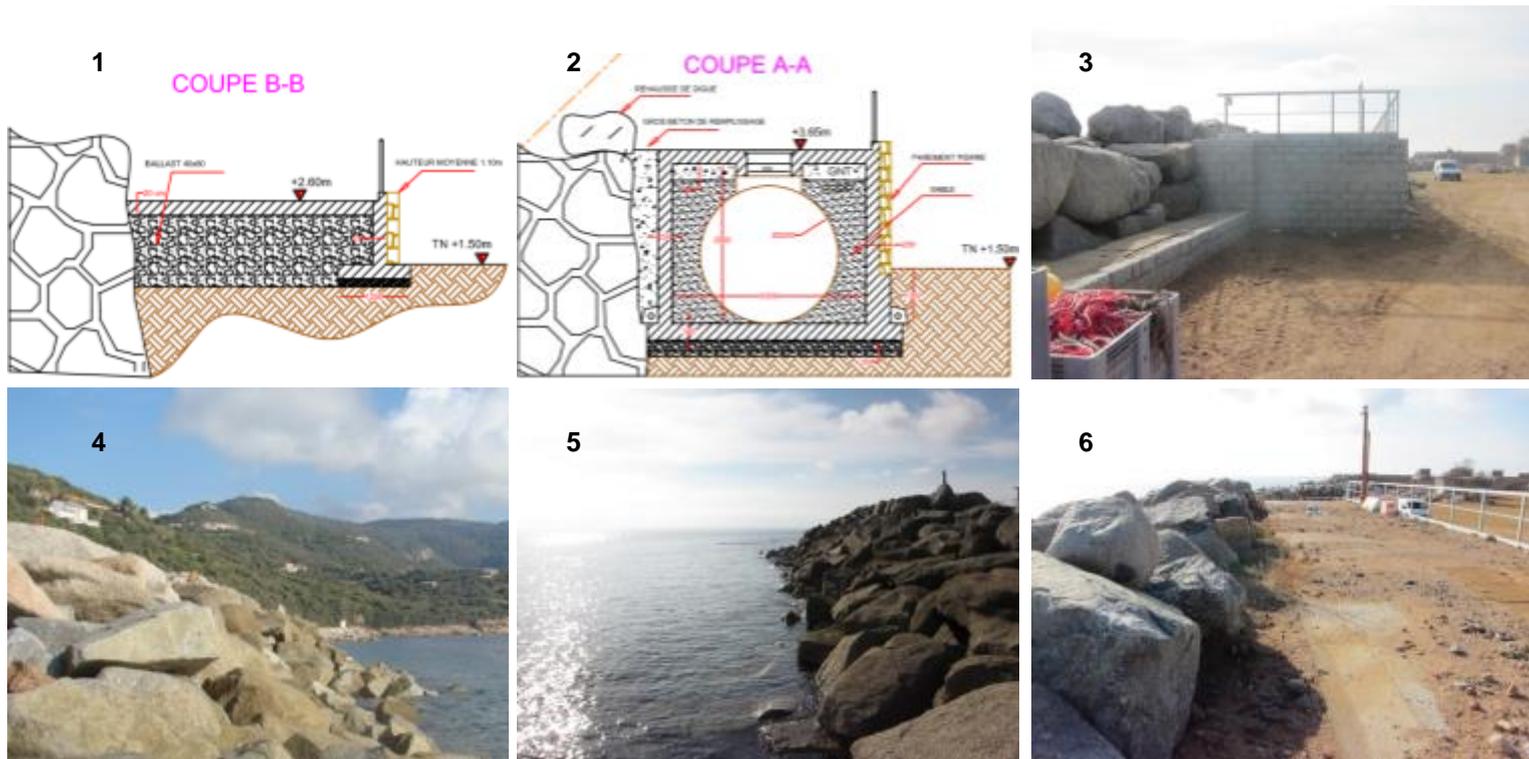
Ouvrage de la zone 3, en 1 la coupe des installations nouvelles au niveau de la rampe d'accès, en 2 la coupe des installations nouvelles au niveau des cuves, en 3 vue de l'arrière de l'ouvrage depuis le terre-plein au Nord-Est de la zone, en 4 vue de la digue depuis le Sud-Ouest de la zone, en 5 vue de l'ouvrage depuis l'extrémité Nord-Est et en 6 vue en arrière de l'ouvrage depuis la plateforme de carburant (Coupes extraites du plan d'implantations des installations nouvelles, photos Nov. 2018)
